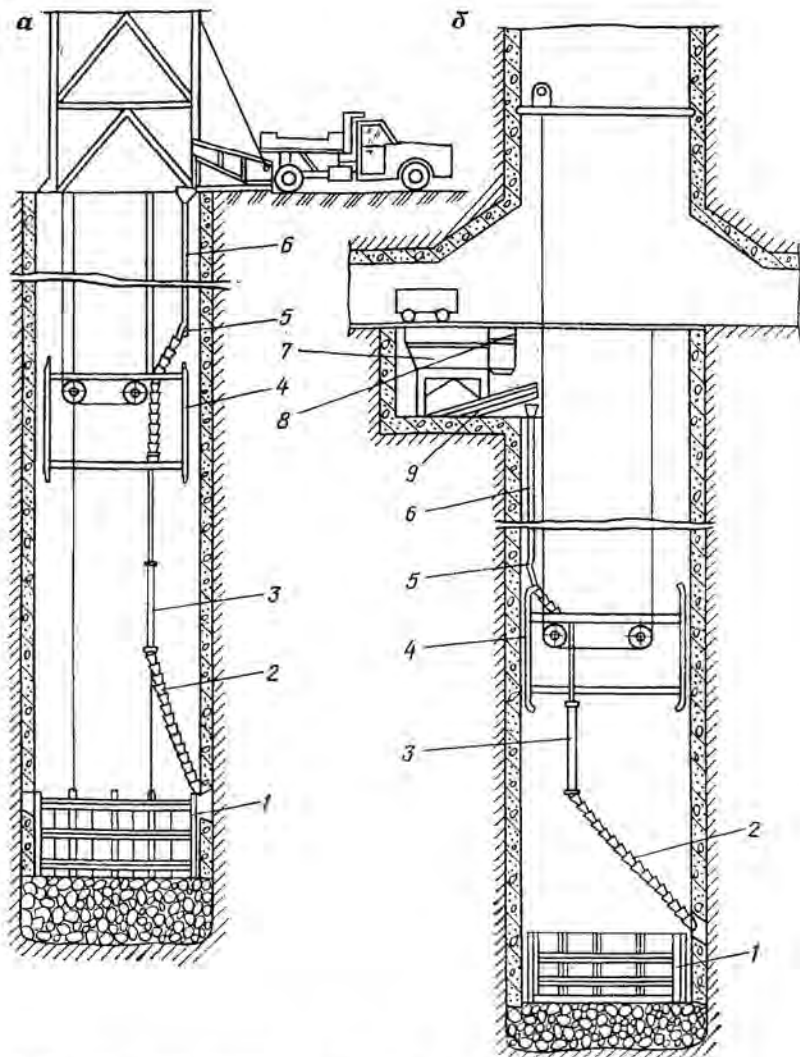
Возведение бетонной крепи при углубке стволов по схемам:
